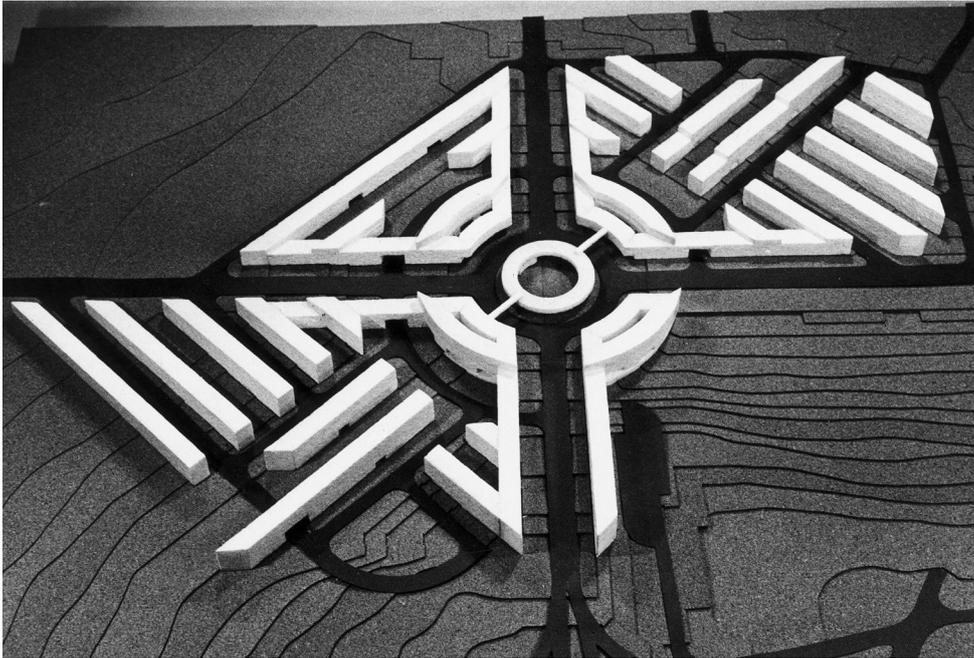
Plano de pormenor: fotografia da maquete do conjunto
